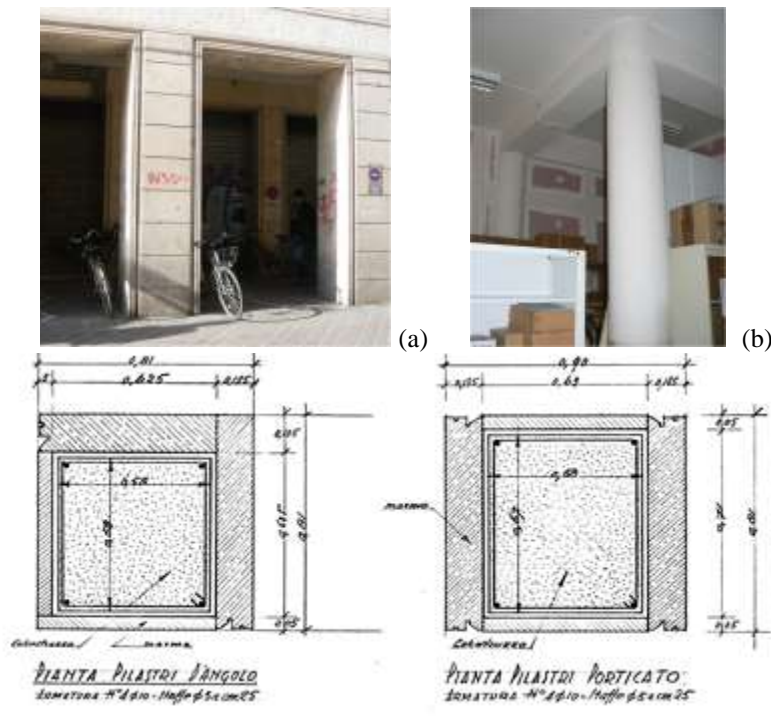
Pilastri in c.a. al piano terra (a) esterni (porticato) e (b) interni (archivio); (c) dettaglio dell'armatura dei pilastri del porticato (progetto preliminare).
